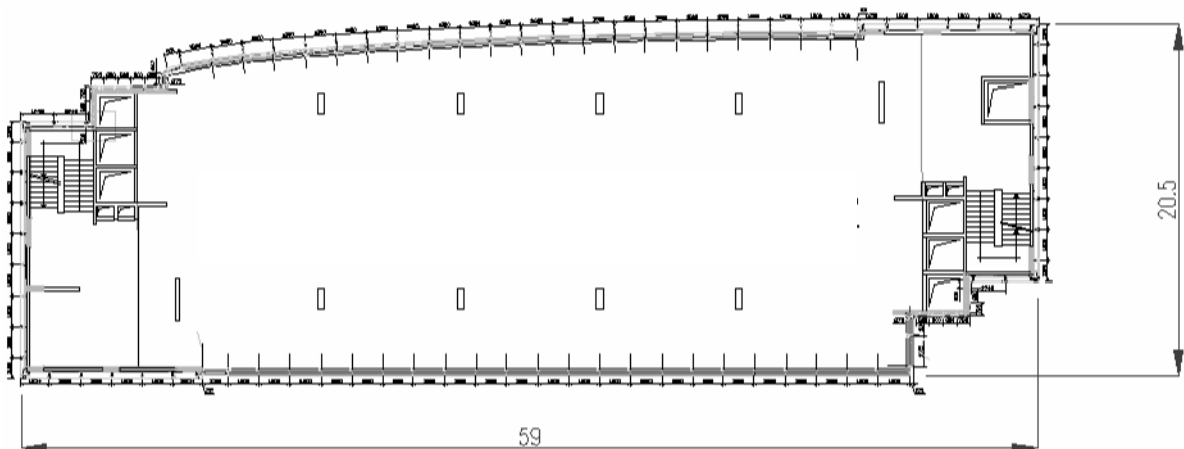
Planta do piso tipo (piso 0 a 6)
